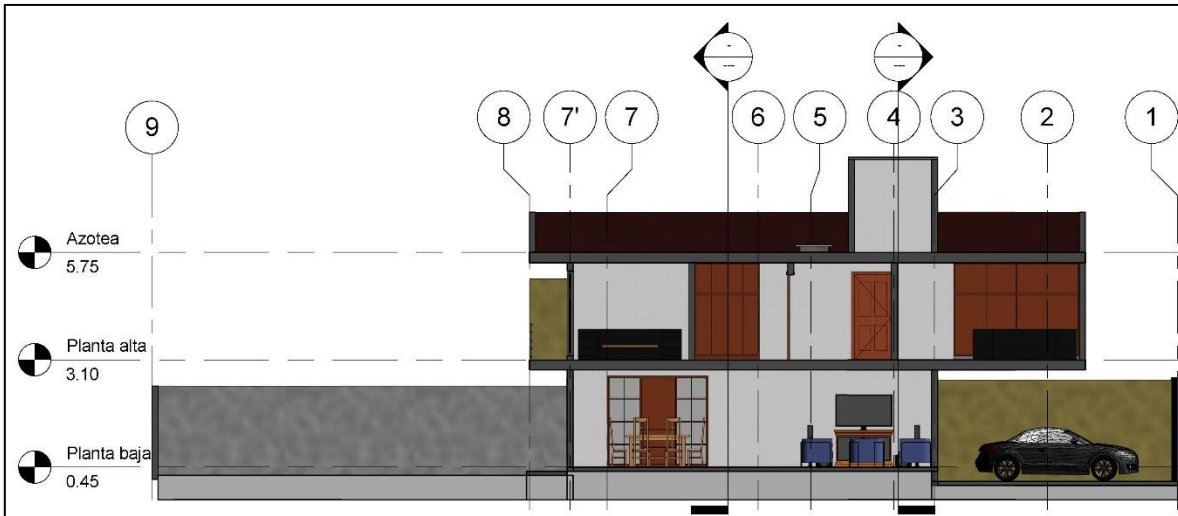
Plano de vivienda no sustentable: sección longitudinal 01. Fuente: autoría propia
